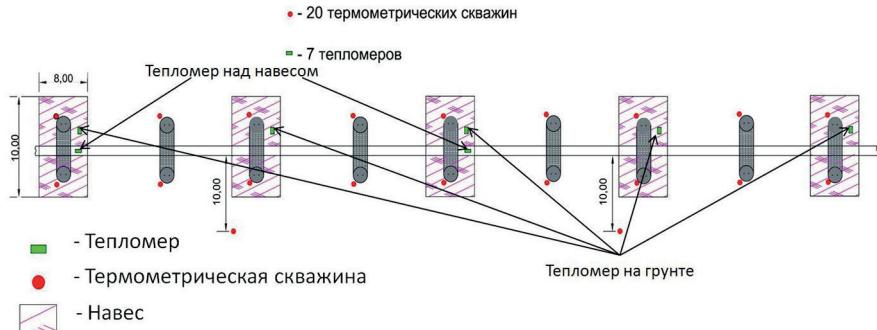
Схема размещения термометрических скважин и датчиков теплового потока под навесами над опорами надземного нефтепровода
